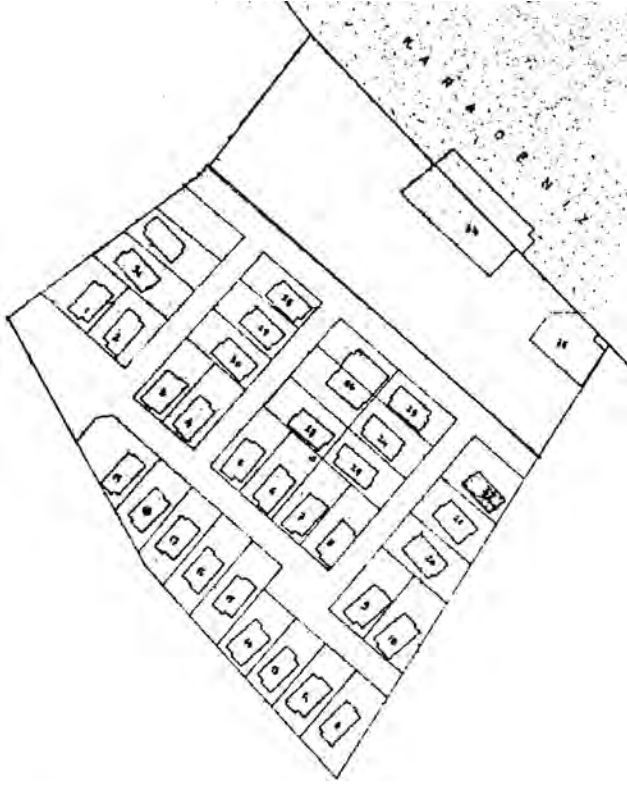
2 No'lu Site Vaziyet Planı ve Genel Görünüşü.
